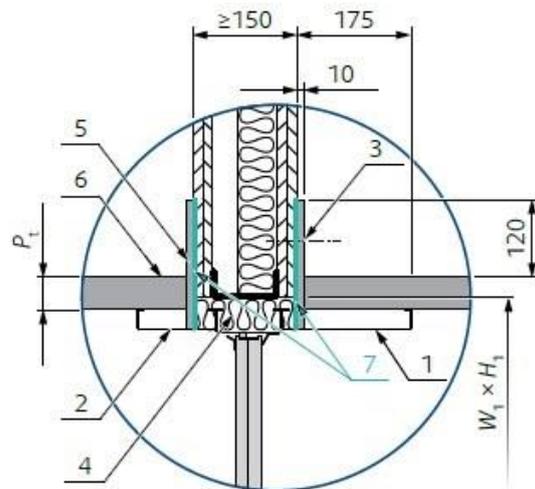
(E190S) Sezione trasversale di ② installazione soft crossing in parete flessibile
